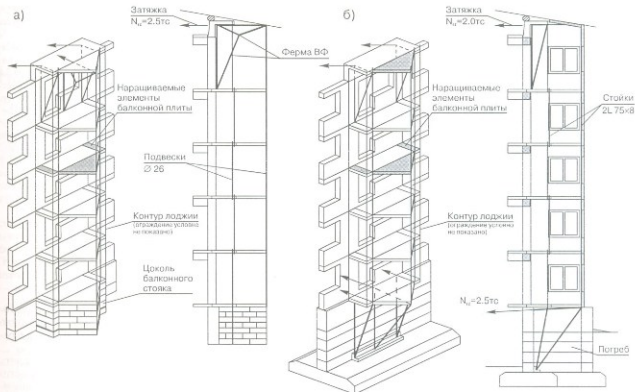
Устройство лоджий и теплых эркеров: а — с установкой ферм ВФ сверху под карнизами и закреплением балконных уширенных плит на подвесках; б — с установкой ферм ВФ сверху и внизу и закреплением балконных уширенных плит с помощью жестких трубчатых или уголкового стоек.
